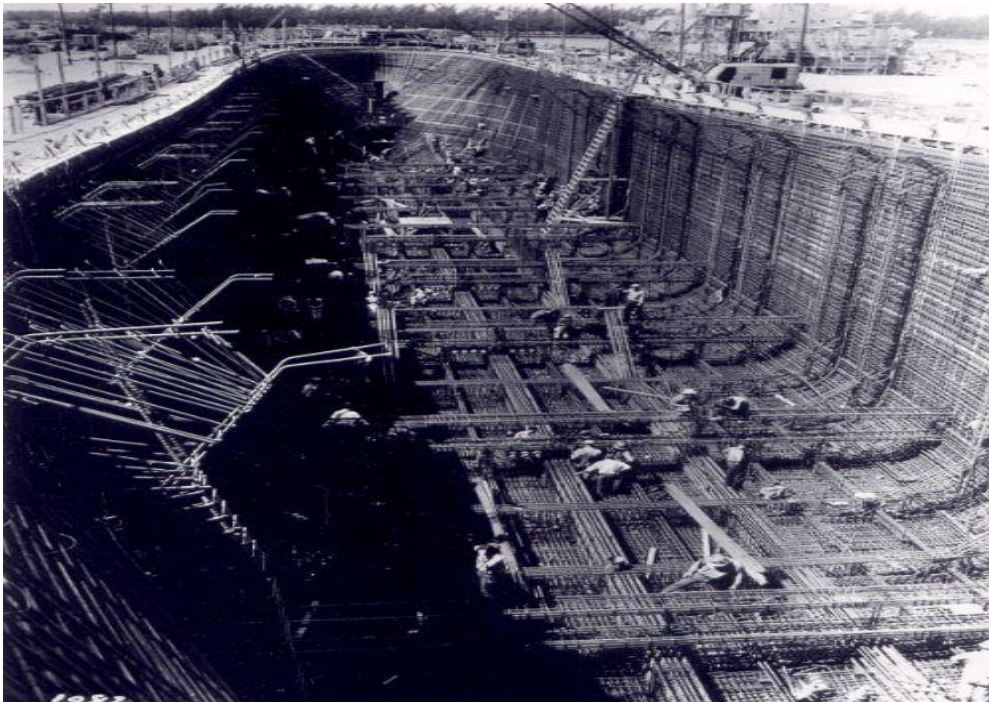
Armaduras de aço cobertas por concreto davam origem aos navios [55]
